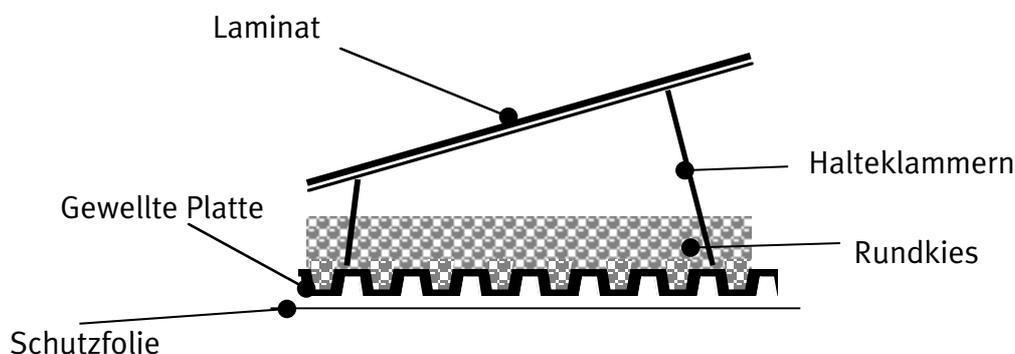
Ansicht der SOLight Variante, welche mit einer gewellten Platte fundiert wird.
